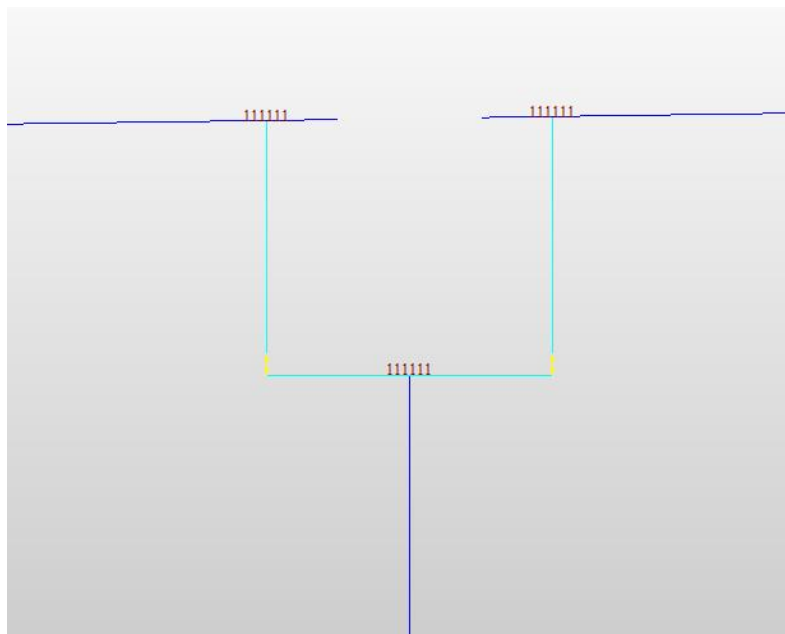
Modellazione del collegamento tra impalcato e sottostrutture
